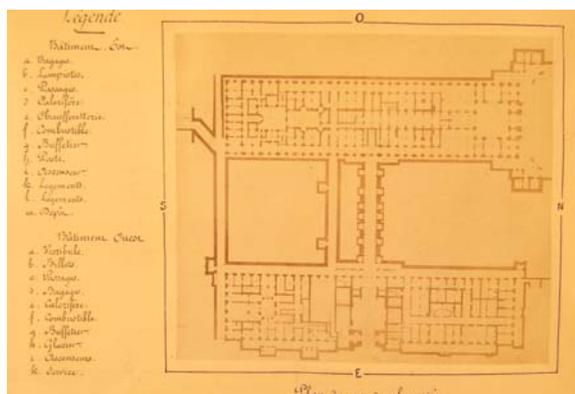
Magdebourg (1876), disposition bilatérale plan de rez-de-chaussée et de premier étage
